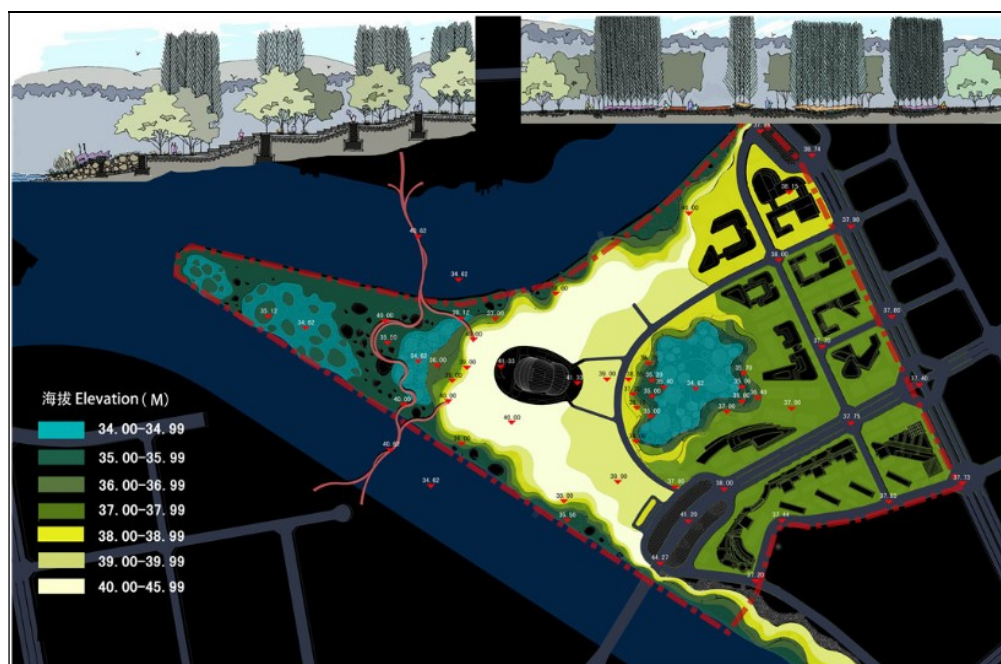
Planta baixa e corte do Yanweizhou Park. ⁷
